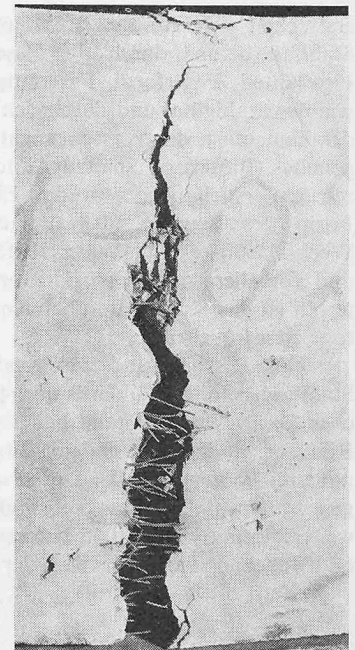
Bruchbild eines Balkens aus Stahlfaserbeton. Im allgemeinen bildet sich nur ein Riss
